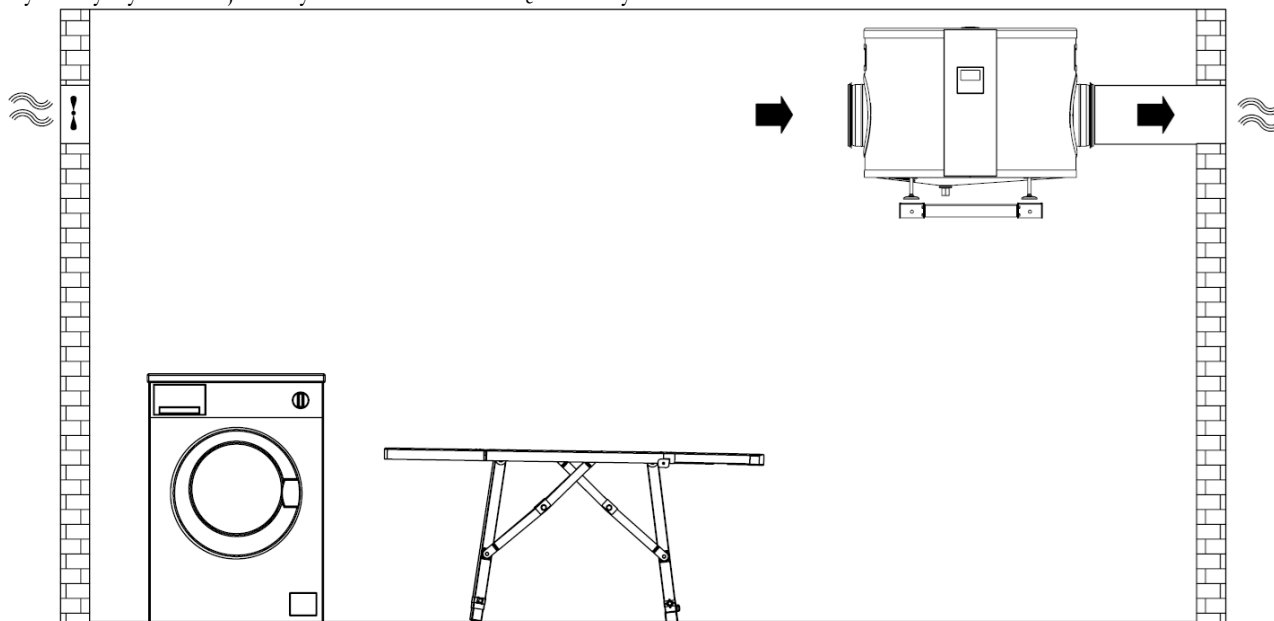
Kierunek montażu kratki wylotowych przewodów powietrznych – montaż w pionie.
